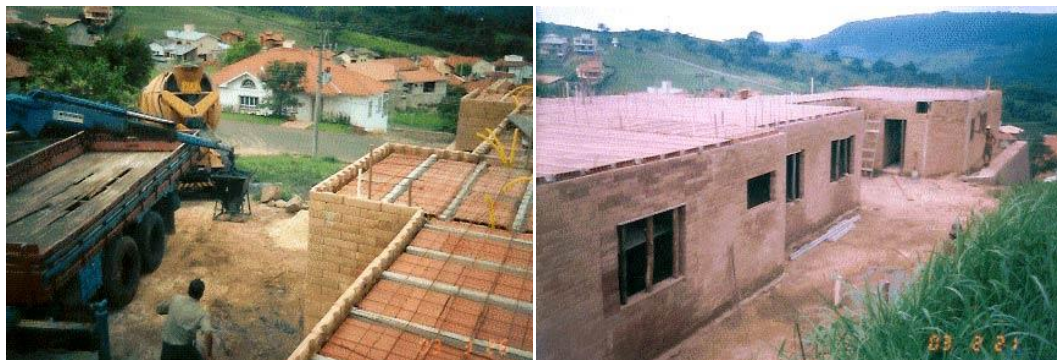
Lajes Apoiadas em Paredes de Alvenaria de Blocos de Solo-Cimento
